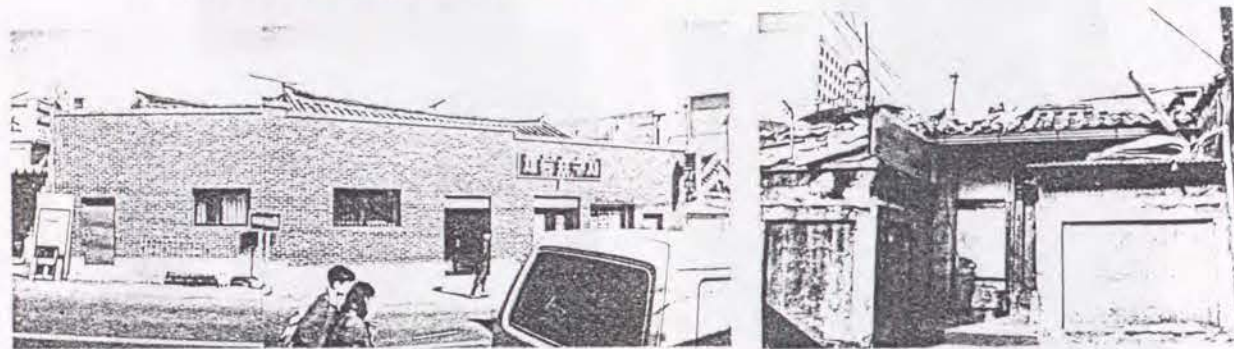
「変形都市型韓屋5」＝前面改造都市型韓屋の例
